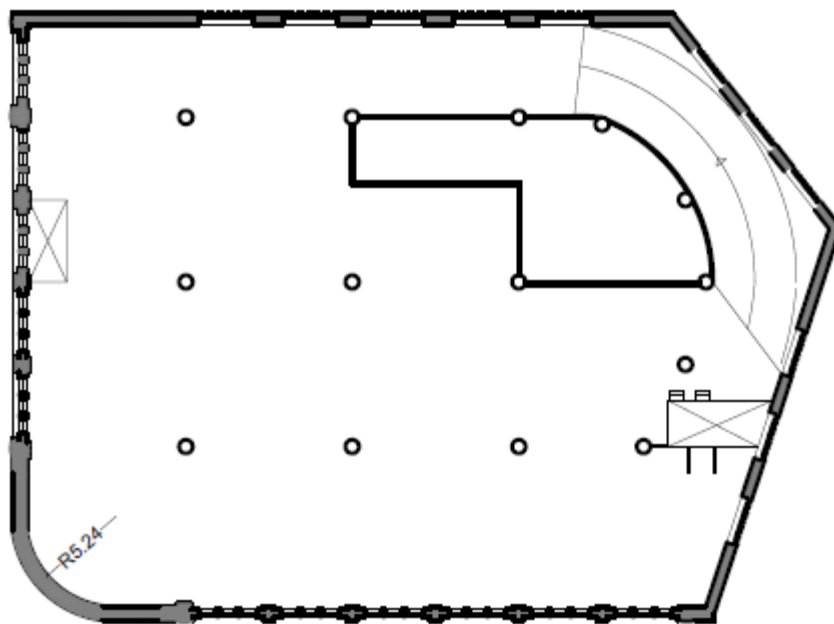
Planta Piso 1 Existente, Escala 1/500 (Autora, 2019)
